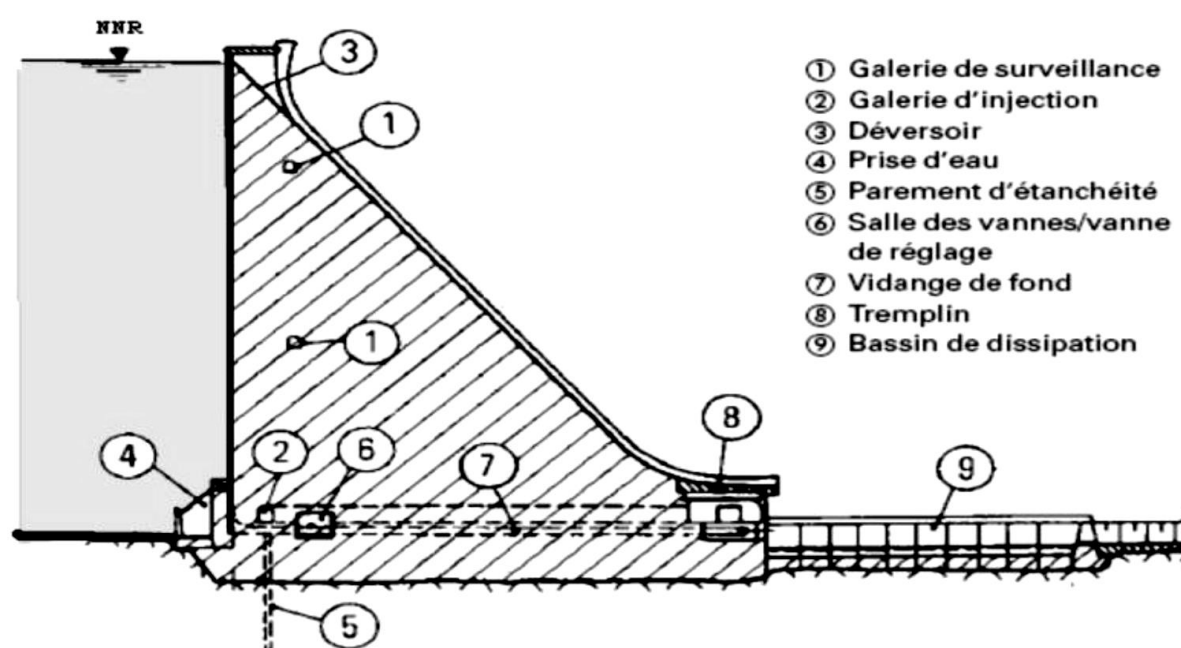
Coupe transversale d'un barrage en béton[6]
